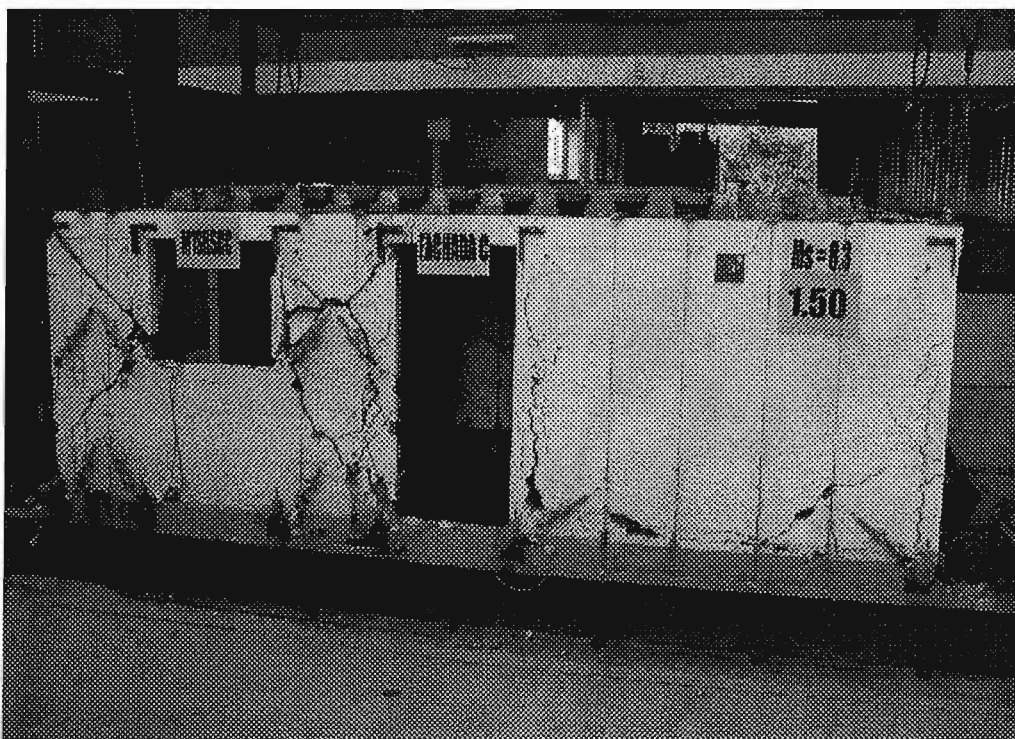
Agrietamiento final en la fachada Norte
